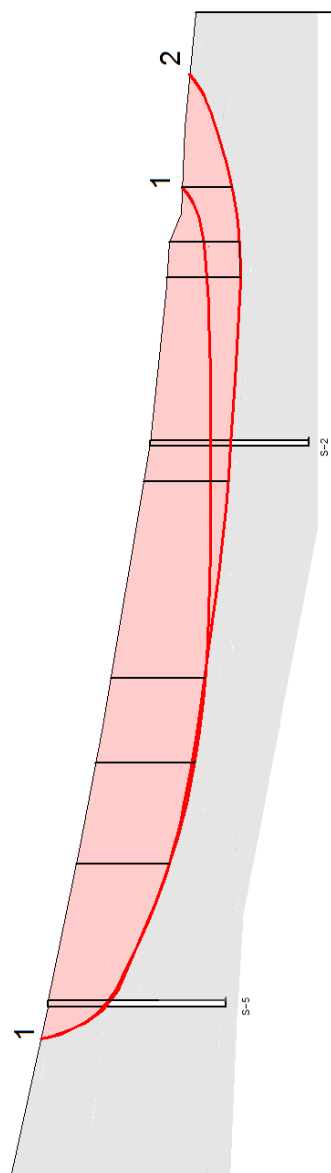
Schema de calcul pentru determinarea stabilității versantului pe terenul nr.2 din satul Vatra
